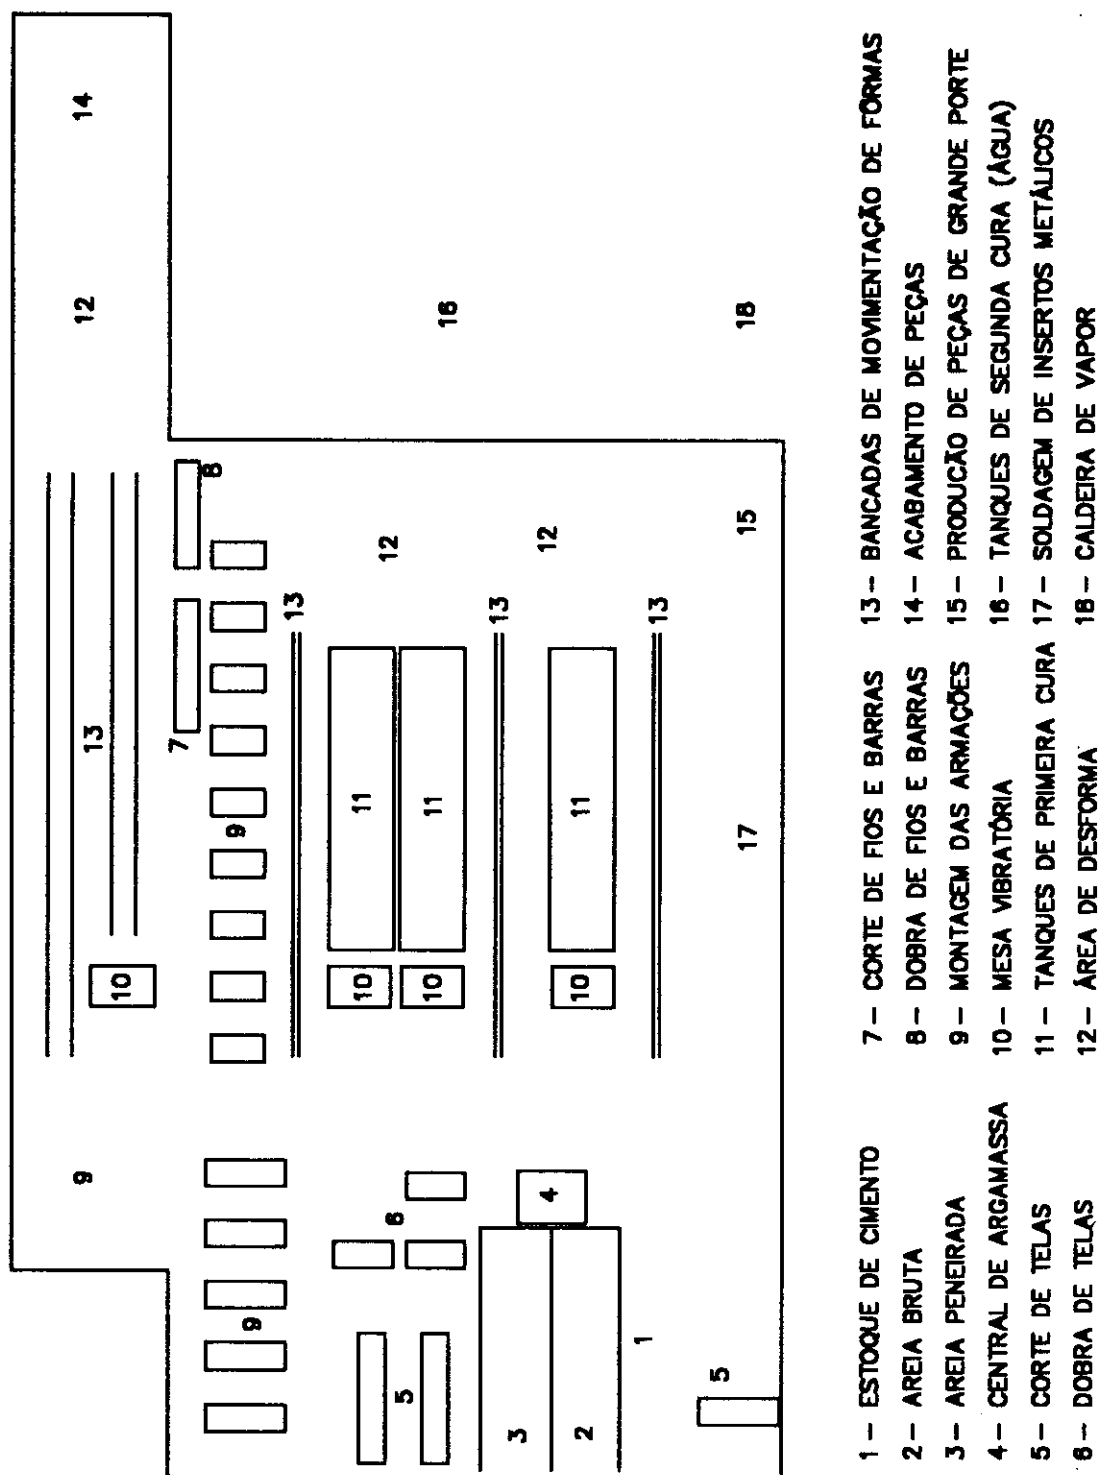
Layout* da usina de produção do Cedec/Emurb (Fábrica 1).
